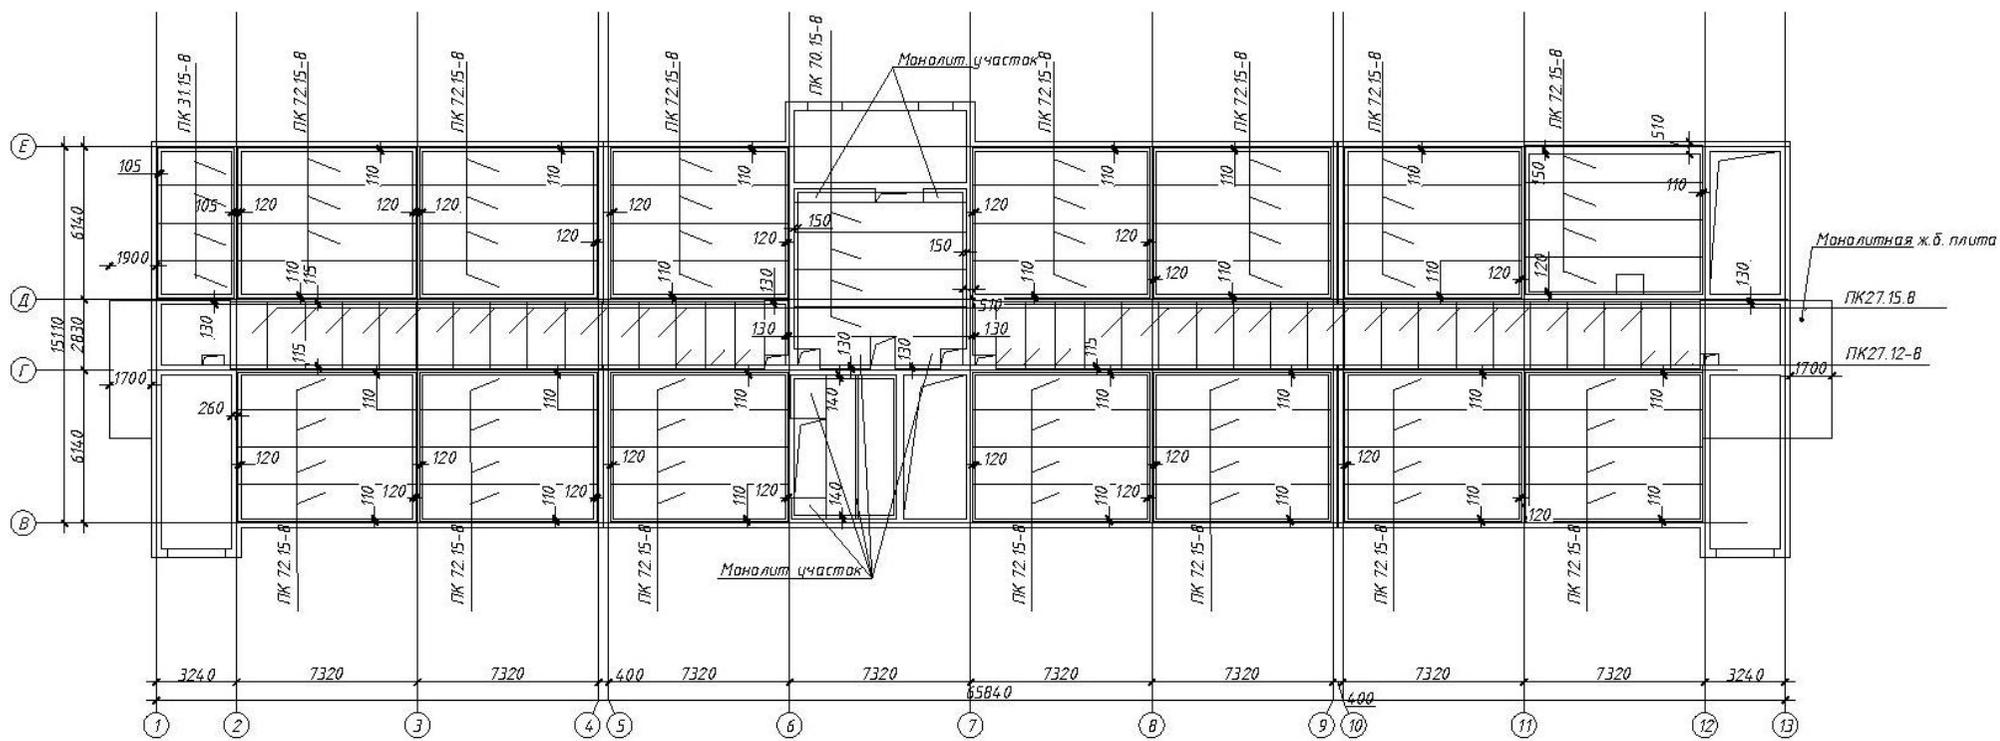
Расположение сборных плит перекрытия на типовой этаж жилой части здания
